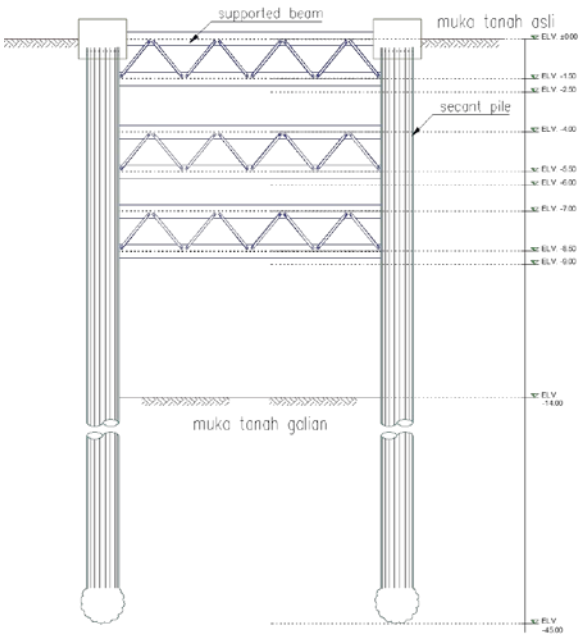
Pemasangan *supported beam* elv. -7.00 hingga -8.50
